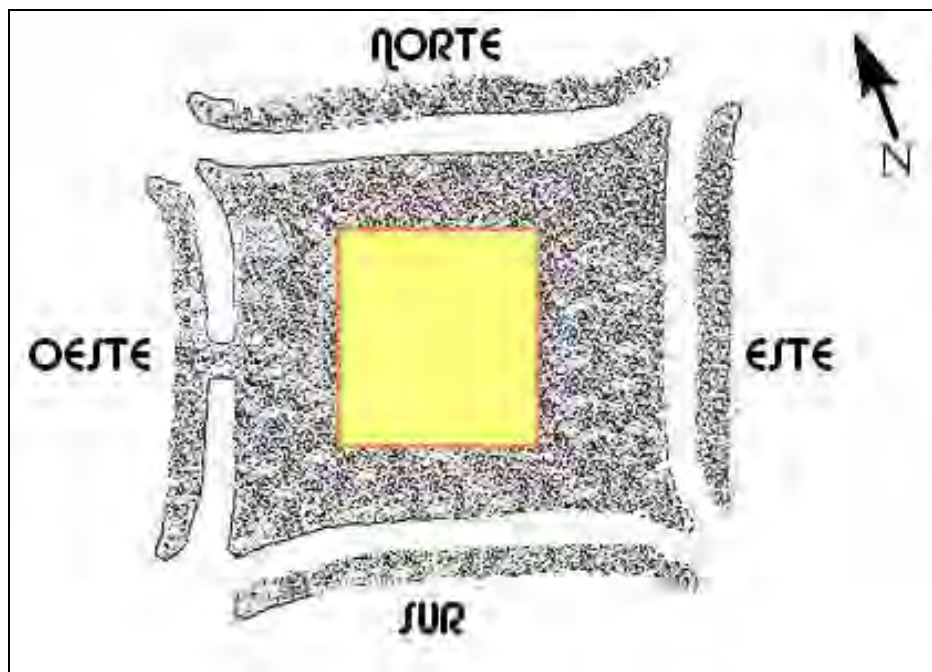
Vista en planta de las zonas de empedrado en torno al edificio, situado en el centro.
